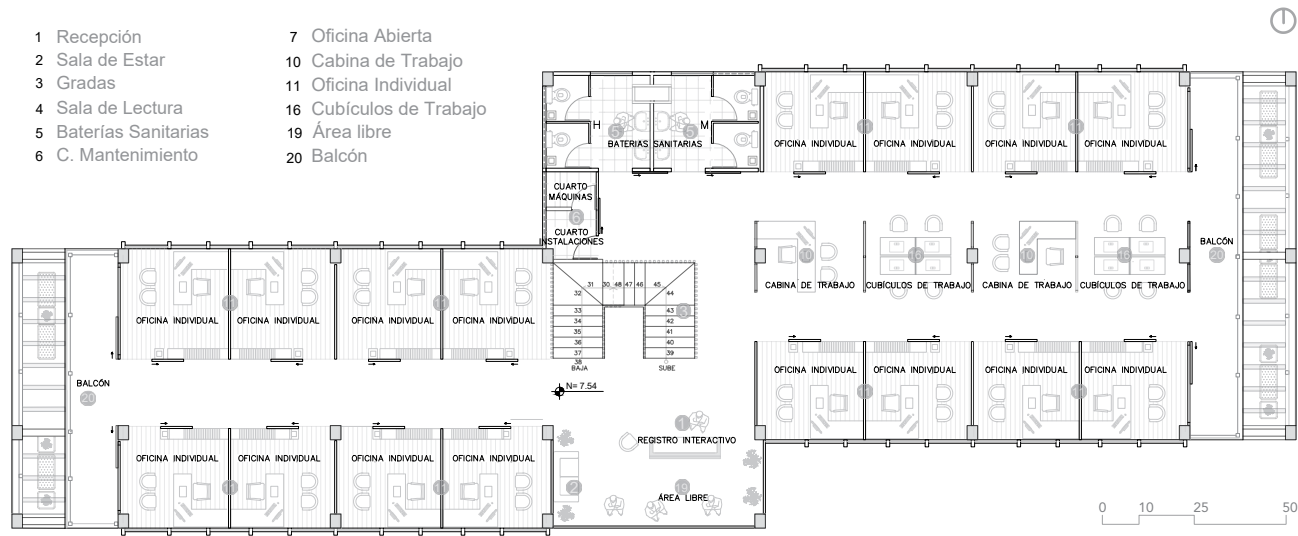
Planos Arquitectónicos, primera Planta alta. Elaborado por: El Autor, 2022.
